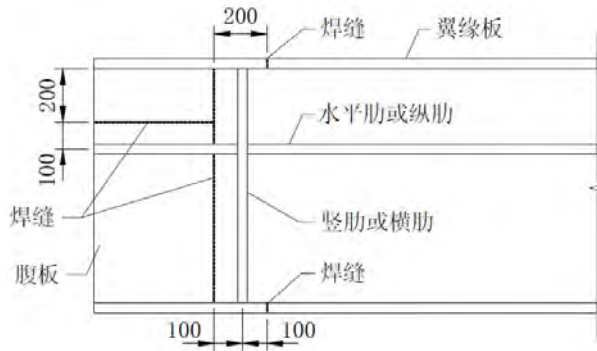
焊缝错开的最小距离（尺寸单位：mm）
